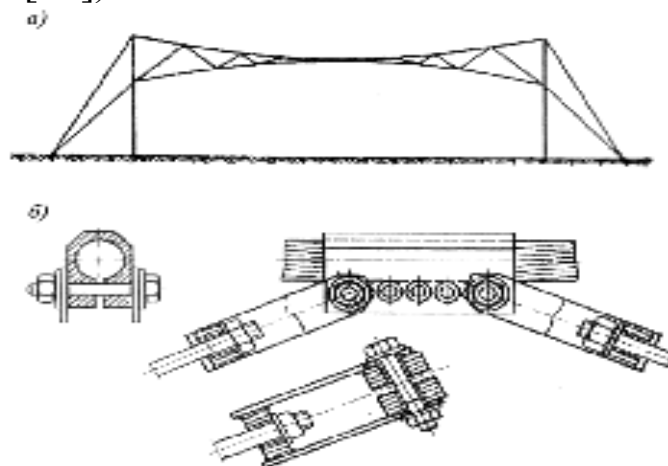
Вантовая ферма: а – схема фермы; б – узел фермы
